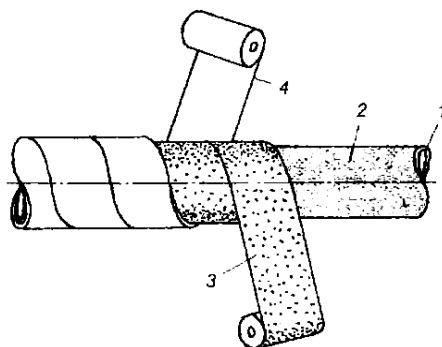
Формирование на трубопроводе покрытия на основе липких полимерных лент: 1 – стальной трубопровод; 2 – слой грунтовки; 3 – барьерное покрытие; 4 – защитный слой
